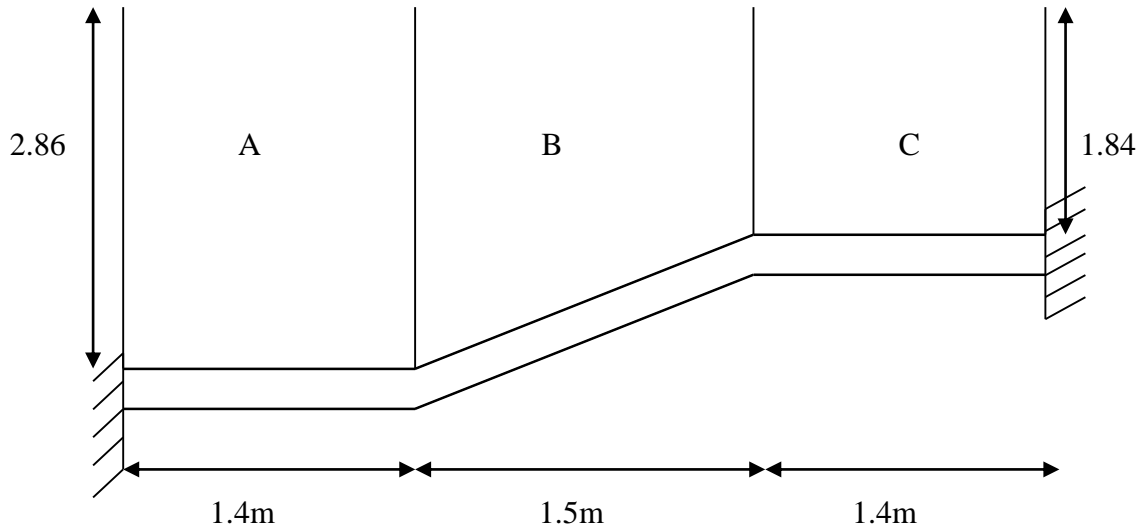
les dimensions et chargement de la poutre brisée.
